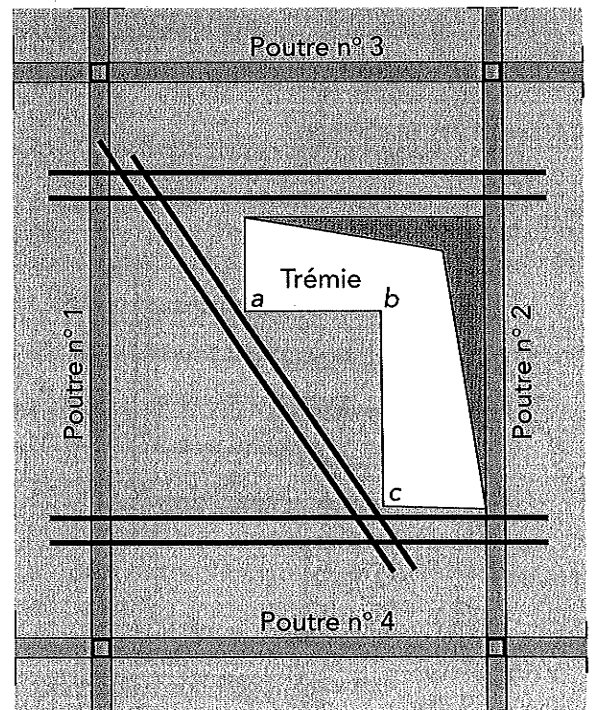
Schéma de poutres noyées dans l'épaisseur de la dalle.
